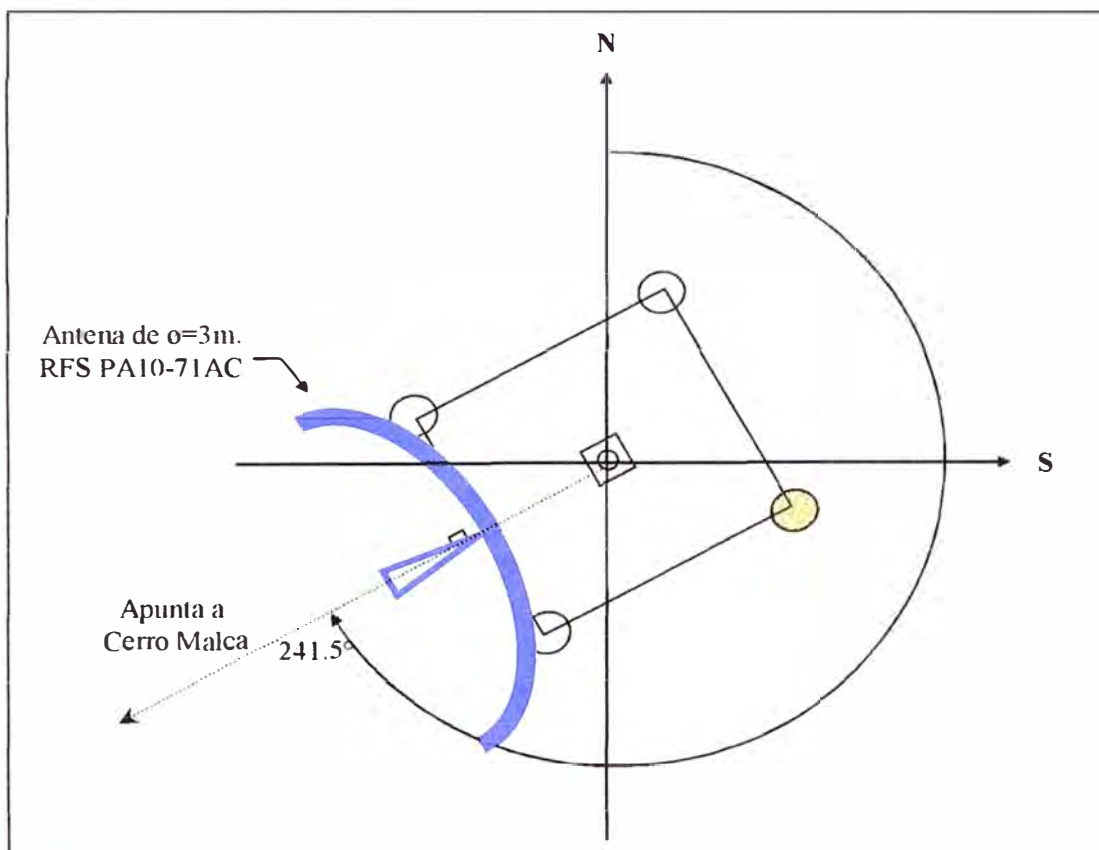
Vista de Planta de la Torre – Toma Sheque
